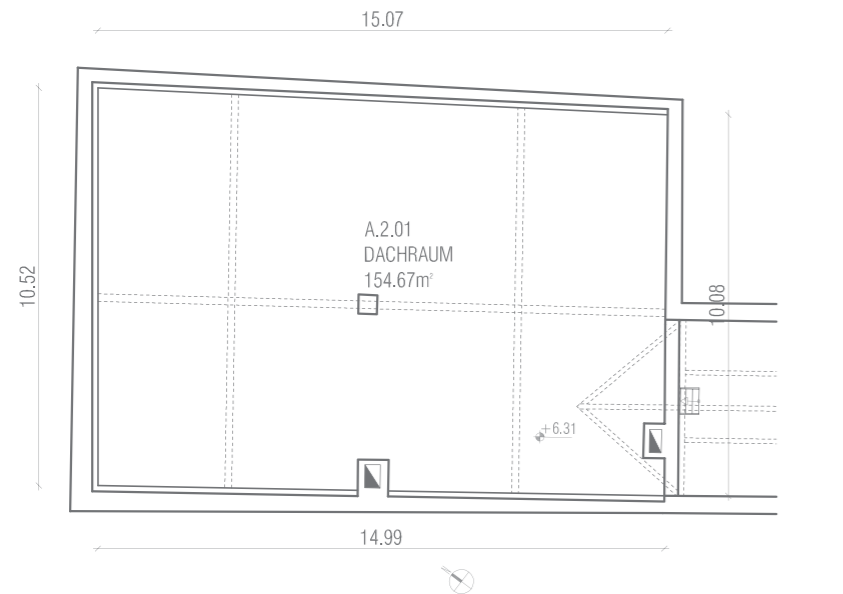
Grundriss Raum A.2.01_1:200
